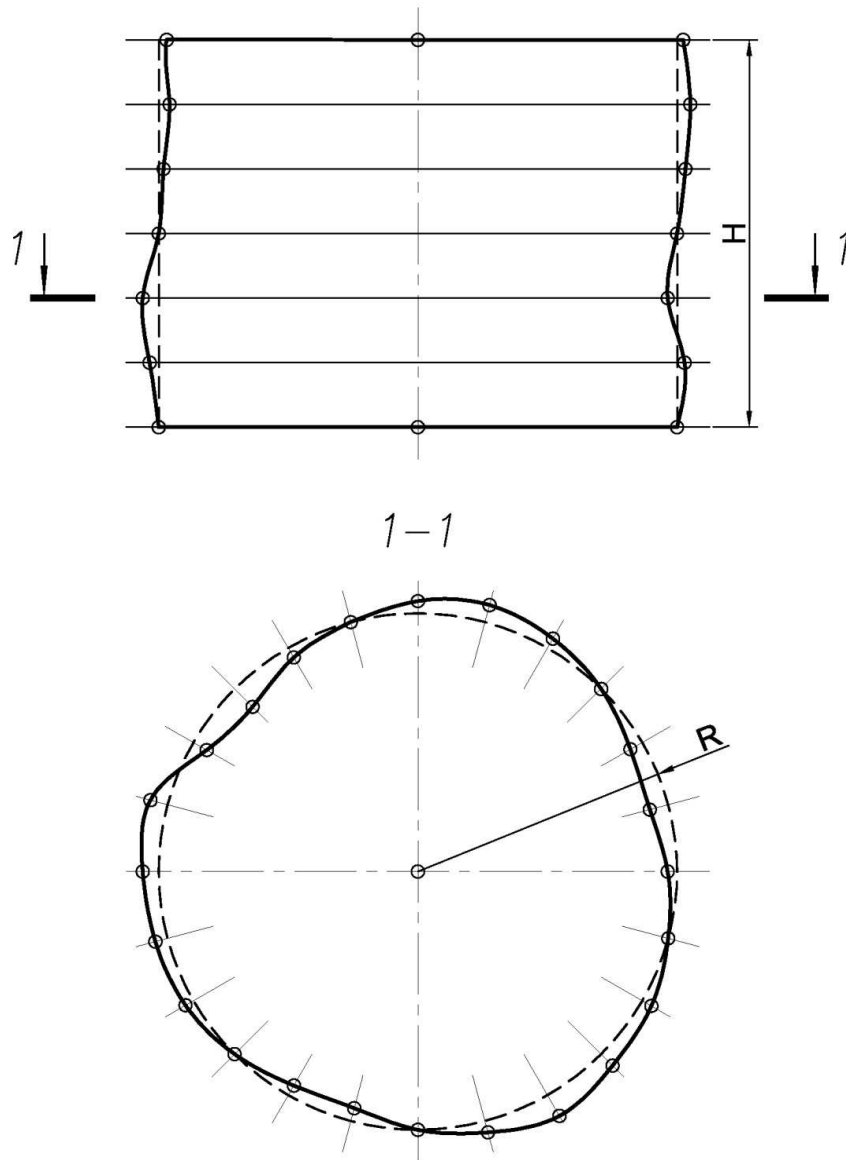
Общая схема стенки резервуара с несовершенствами геометрической формы.
